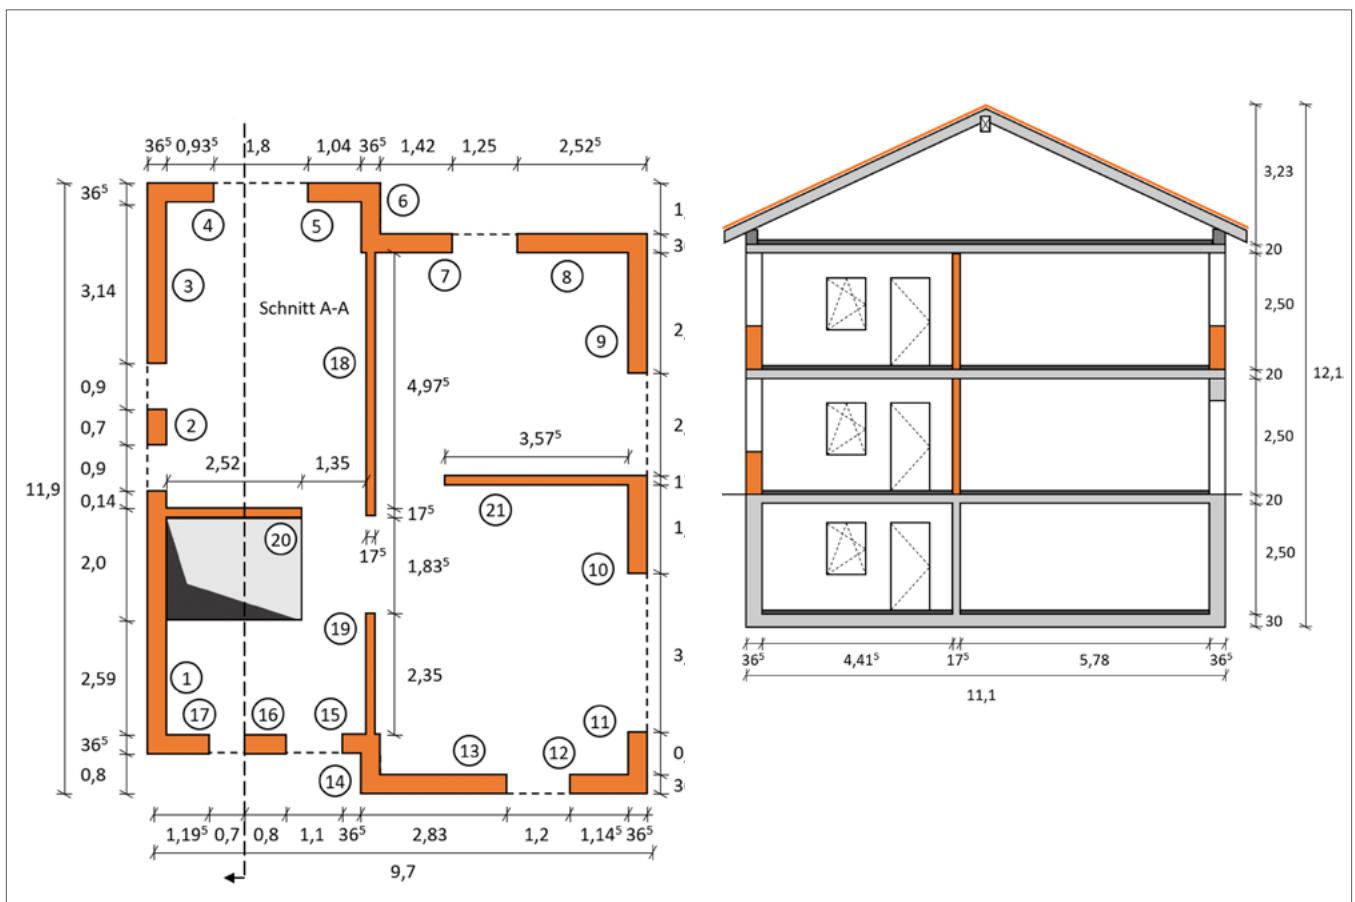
Grundriss und Schnitt A-A durch das Einfamilienhaus
